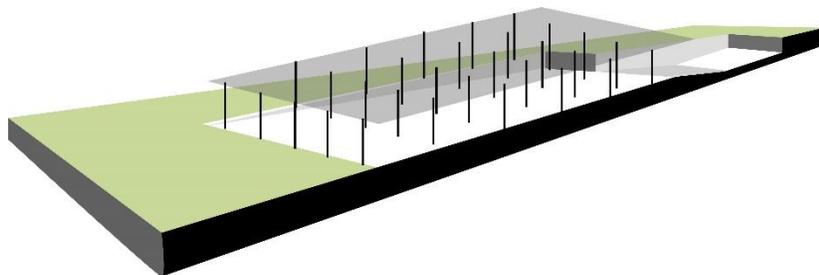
Esquema de estructuras a porticadas, interrupción espacial Pabellón Premiere. Fuente: Elaboración propia.
